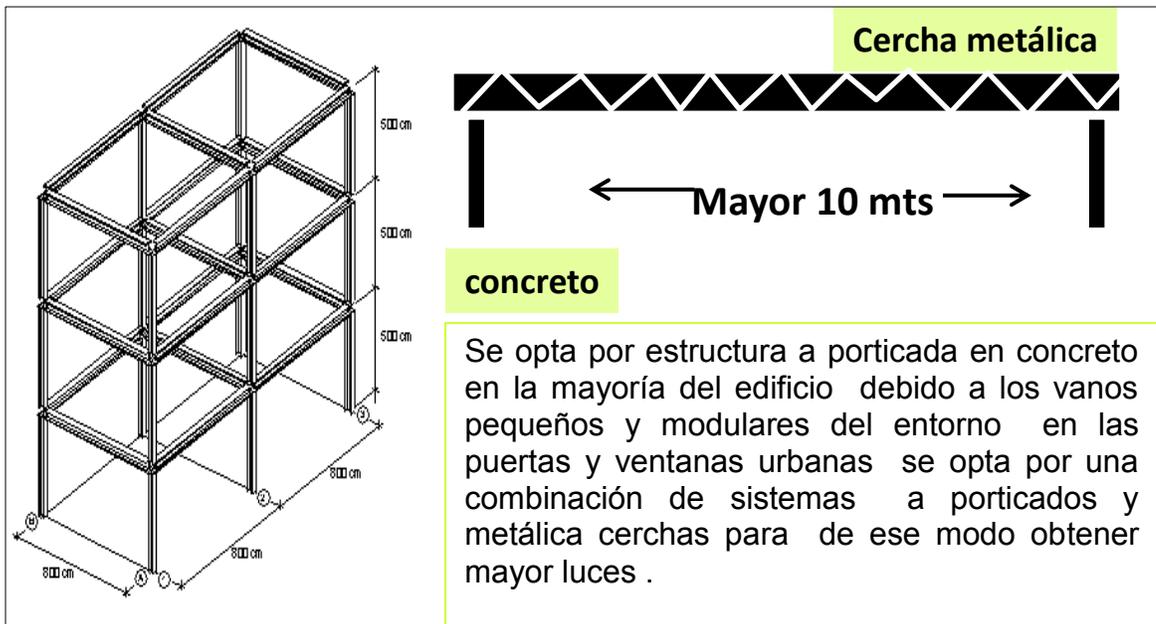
grafica estructura (referente// fuente [www.estructuras .com](http://www.estructuras.com)//
